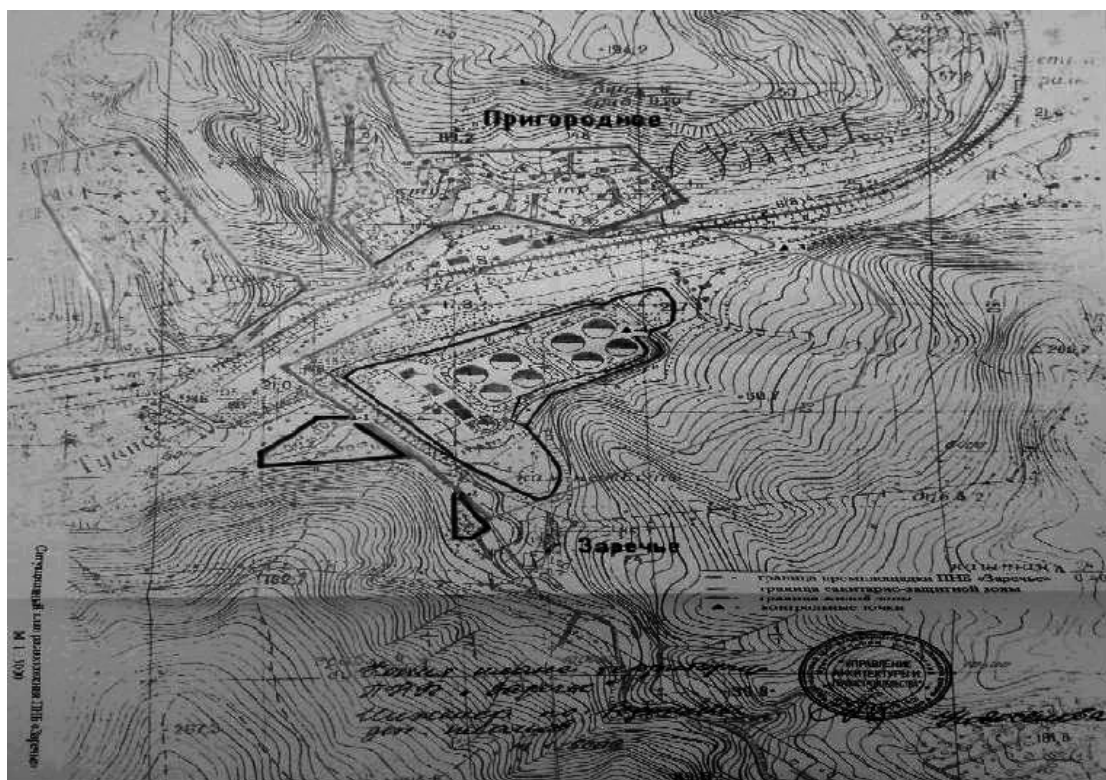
Граница СЗЗ нанесена на план размещения НПС «Заречье»
